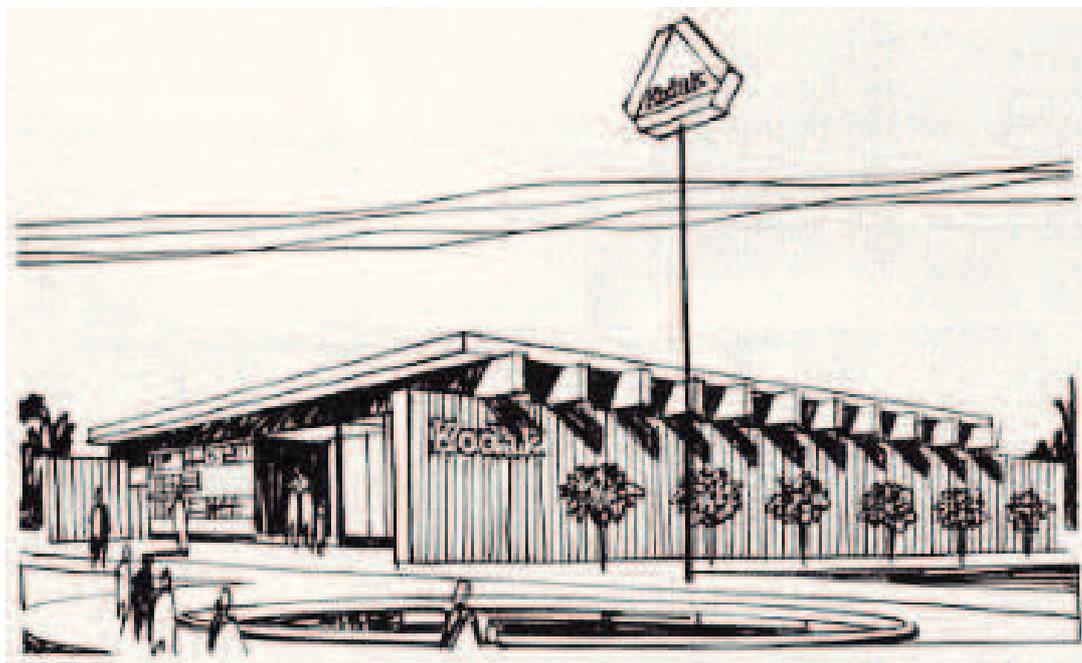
Pavillon de l'entreprise Kodak.
